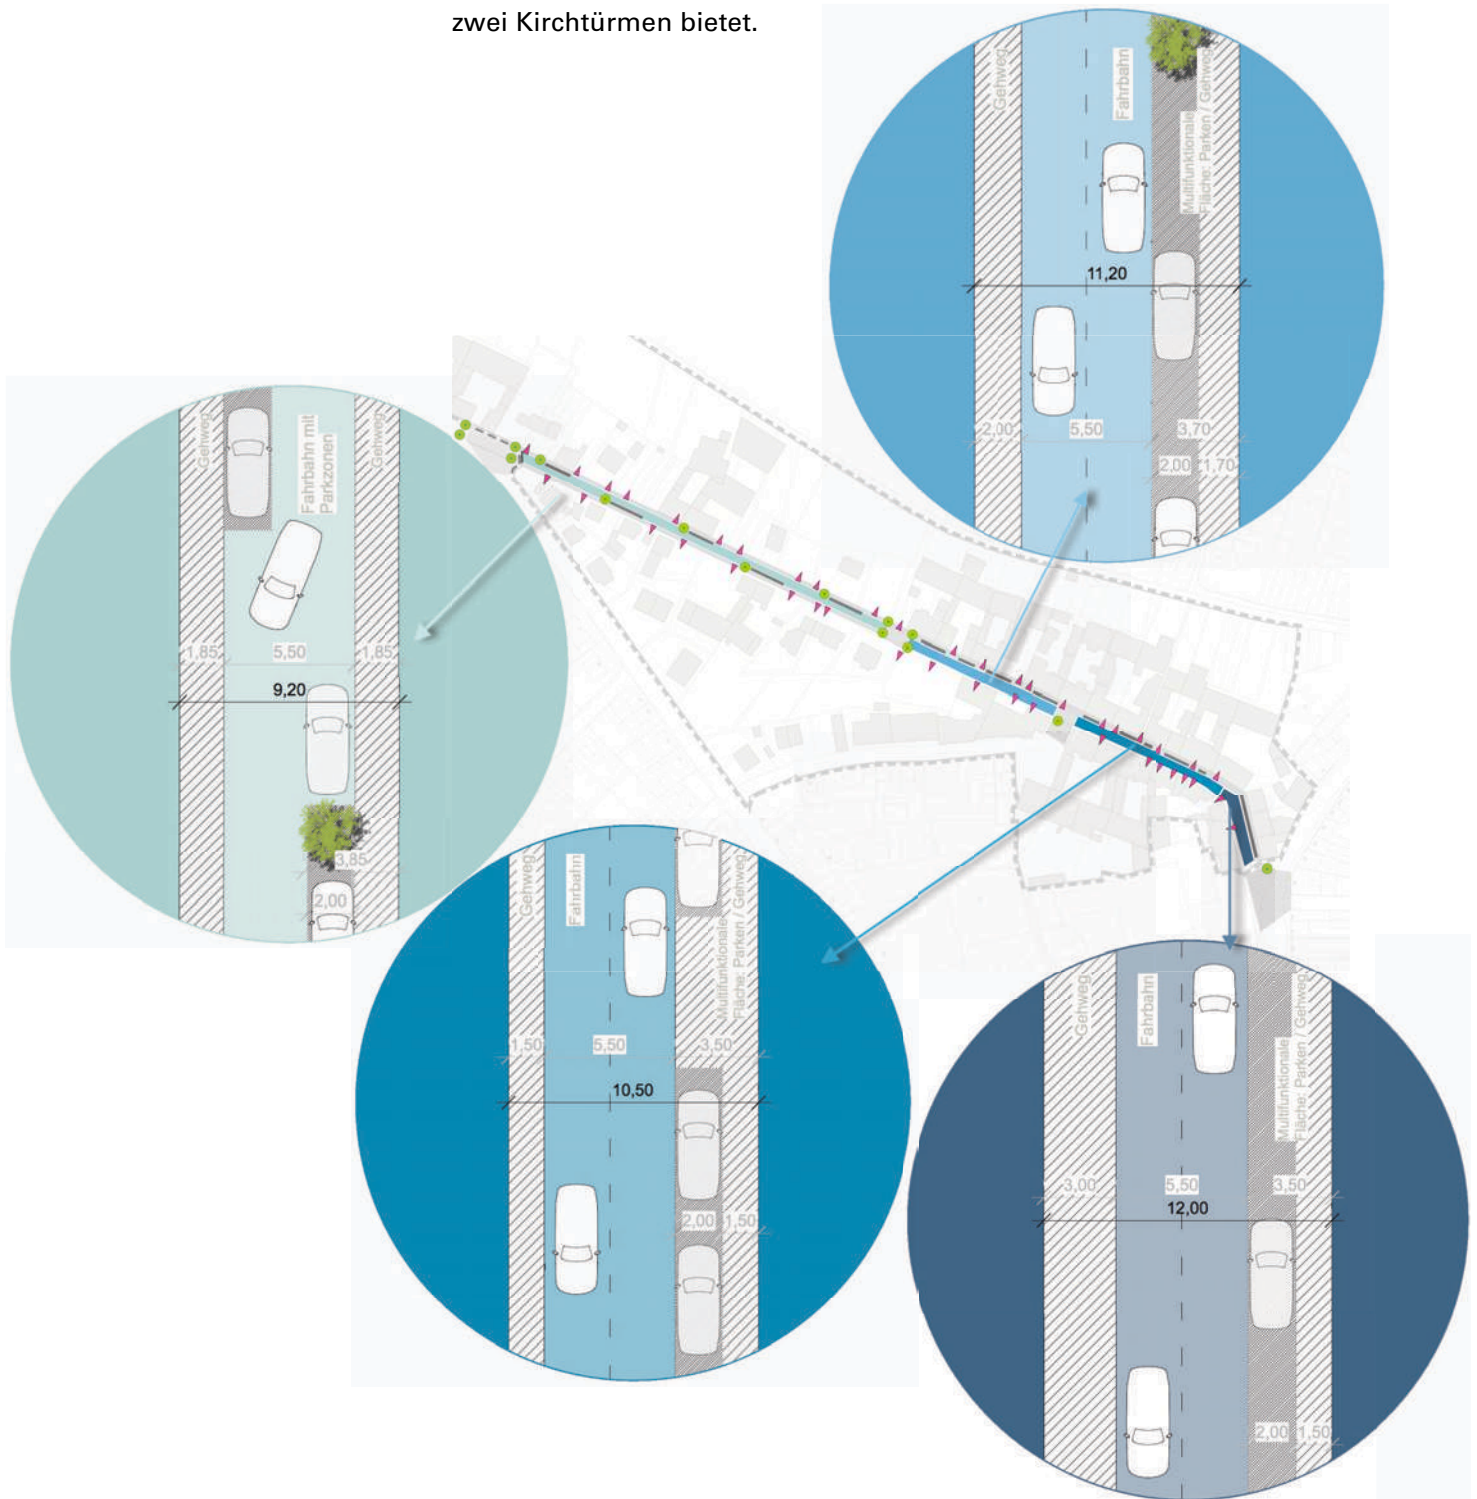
Gliederung der Adelshofer Straße auf Grundlage der heute verfügbaren öffentlichen Flächen
